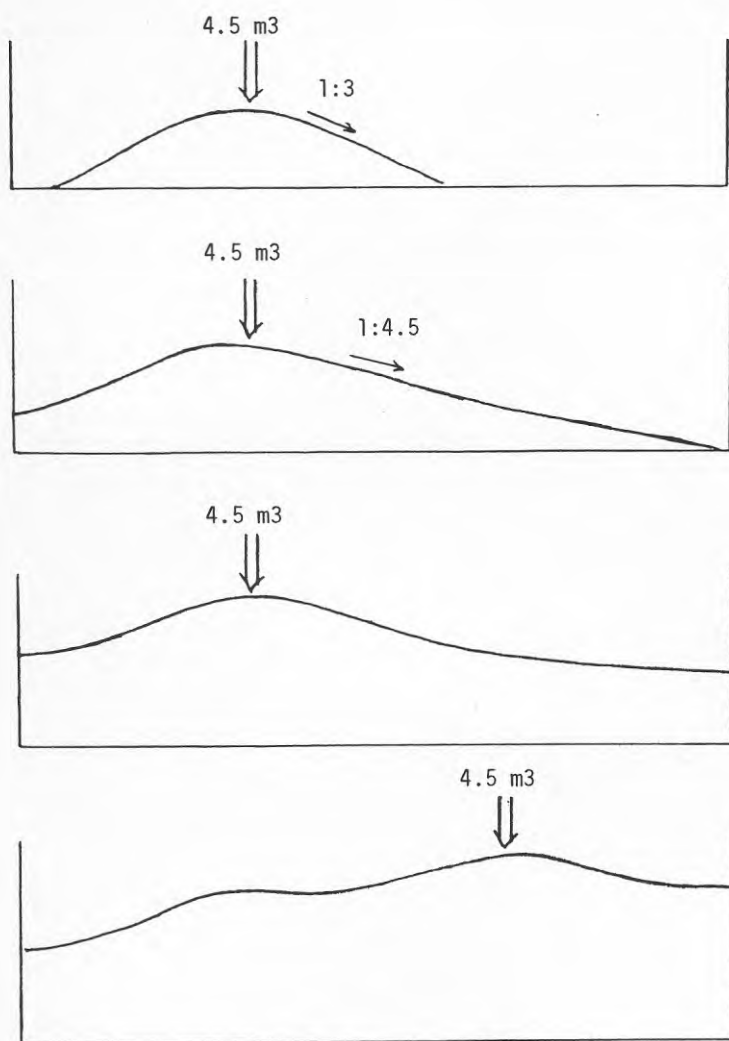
Monolit nr 5. Pejlade betongnivåer i centrumlinjen.
